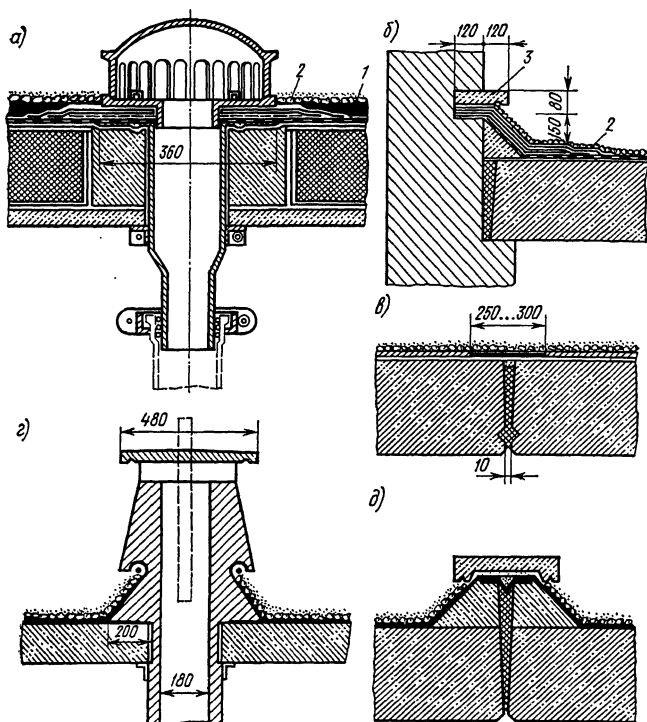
Устройство рулонного ковра в местах примыкания к оборудованию кровли
